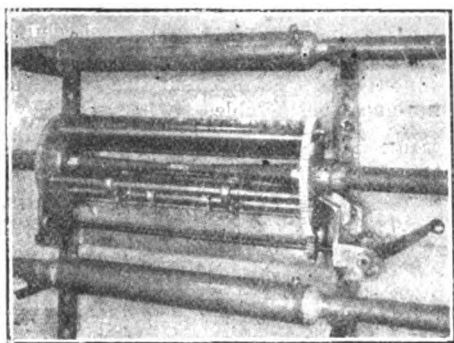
Photographie montrant une machine à enrouler automatiquement du papier autour des joints, installée dans un trou d'homme.
